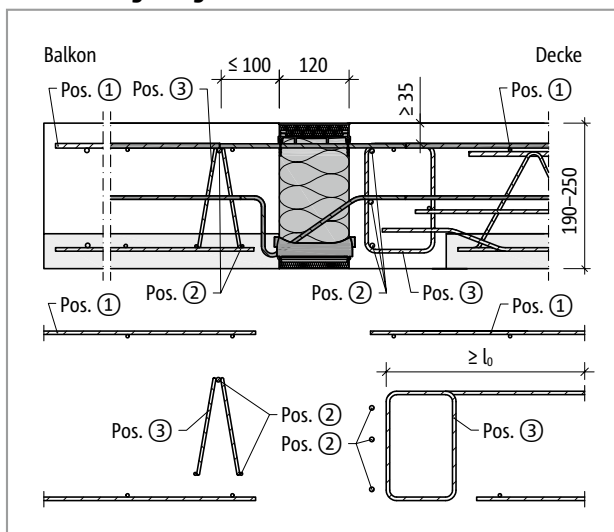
Schöck Isokorb® XT Typ K-F: Bauseitige Bewehrung bei Balkonplattendicke  $h = 190\text{--}250\text{ mm}$  mit Gitterträger (Pos.2:  $5\phi 8$ )
